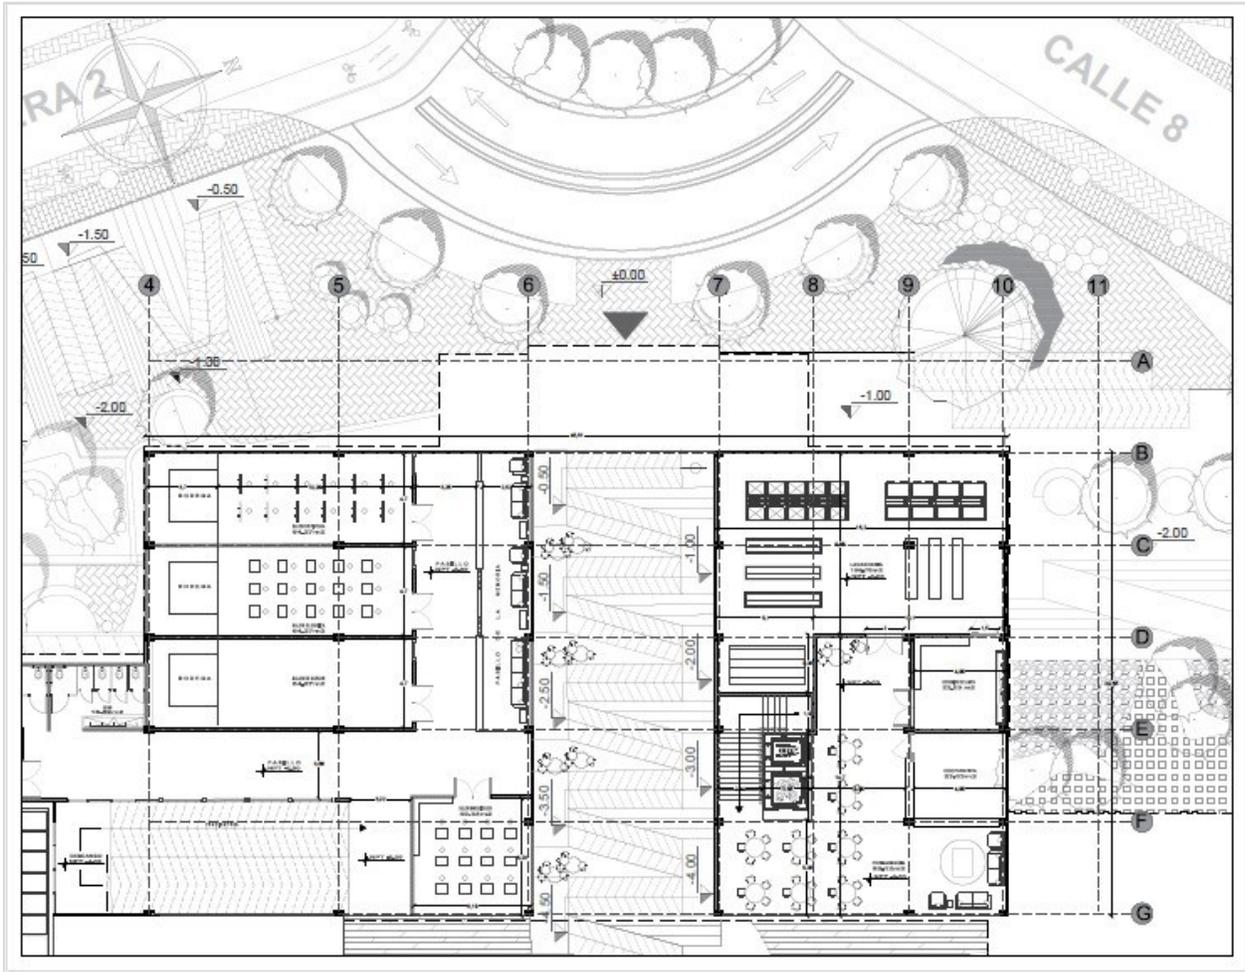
Planta -1 Edificación 1 (Rubiano, 2020)
